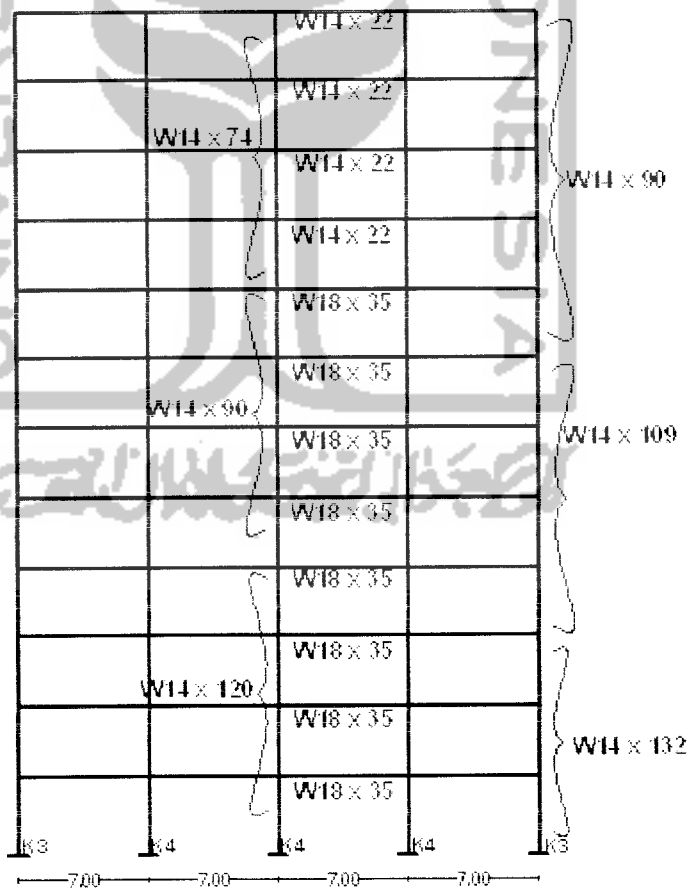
Denah Struktur Dengan Menggunakan Kolom Baja Murni
